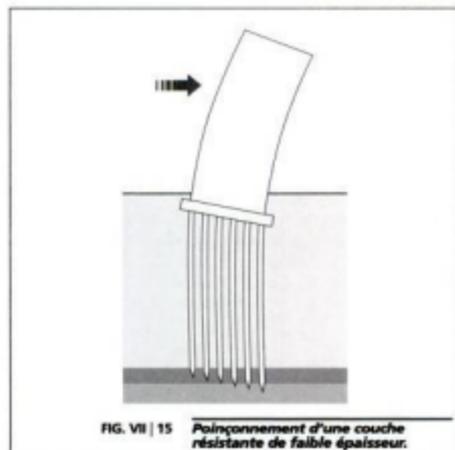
Poinçonnement d'une couche résistante de faible épaisseur.
